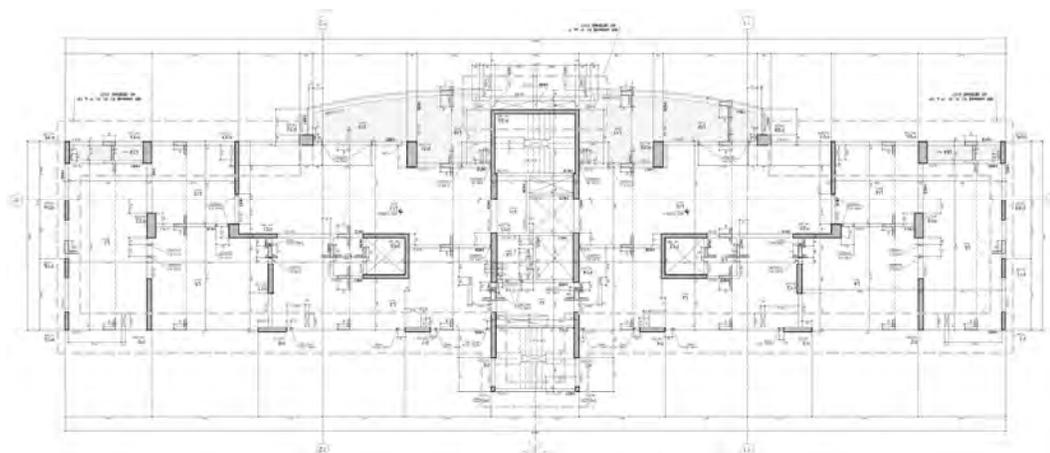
Planta de fôrma do pavimento tipo da Torre Panorama.
